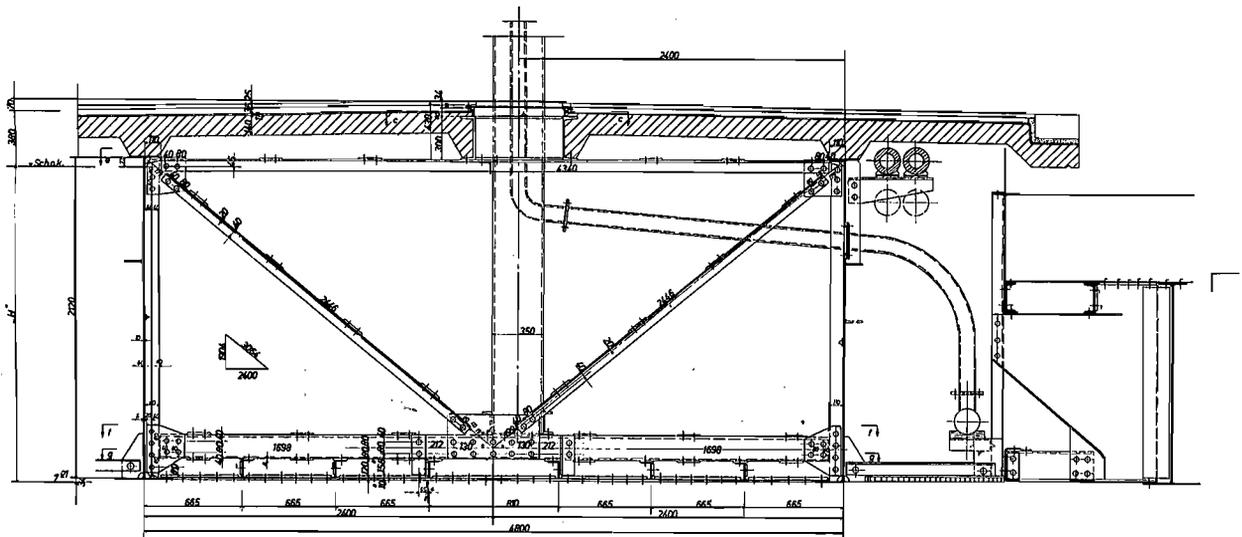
Lasallestraßenbrücke Praterstern, Querschnitt Gleisragwerk
